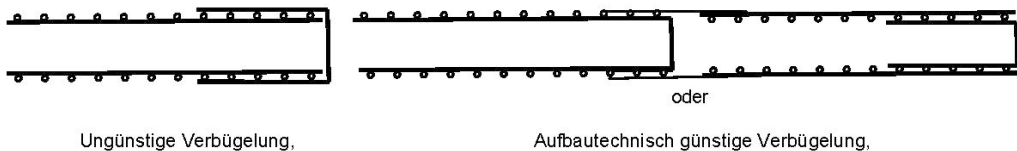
Gegenüberstellung von Umschließung (links) zu Auflage (rechts).
